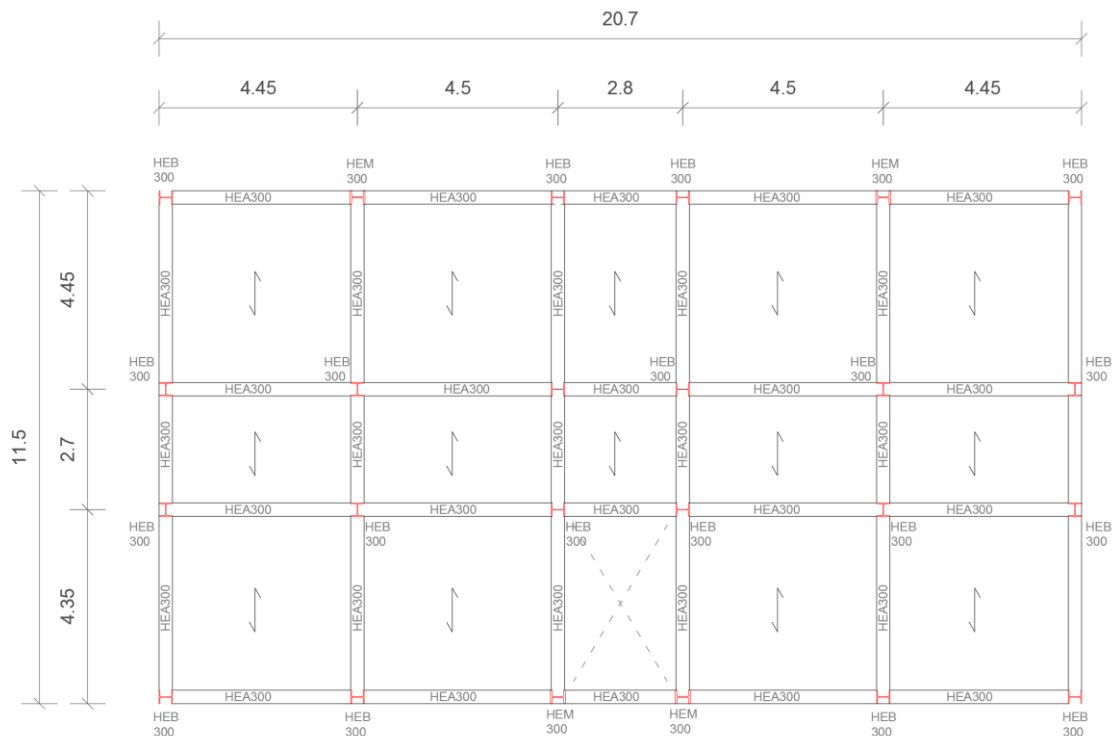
Carpenteria secondo solaio struttura in acciaio a tre piani.
